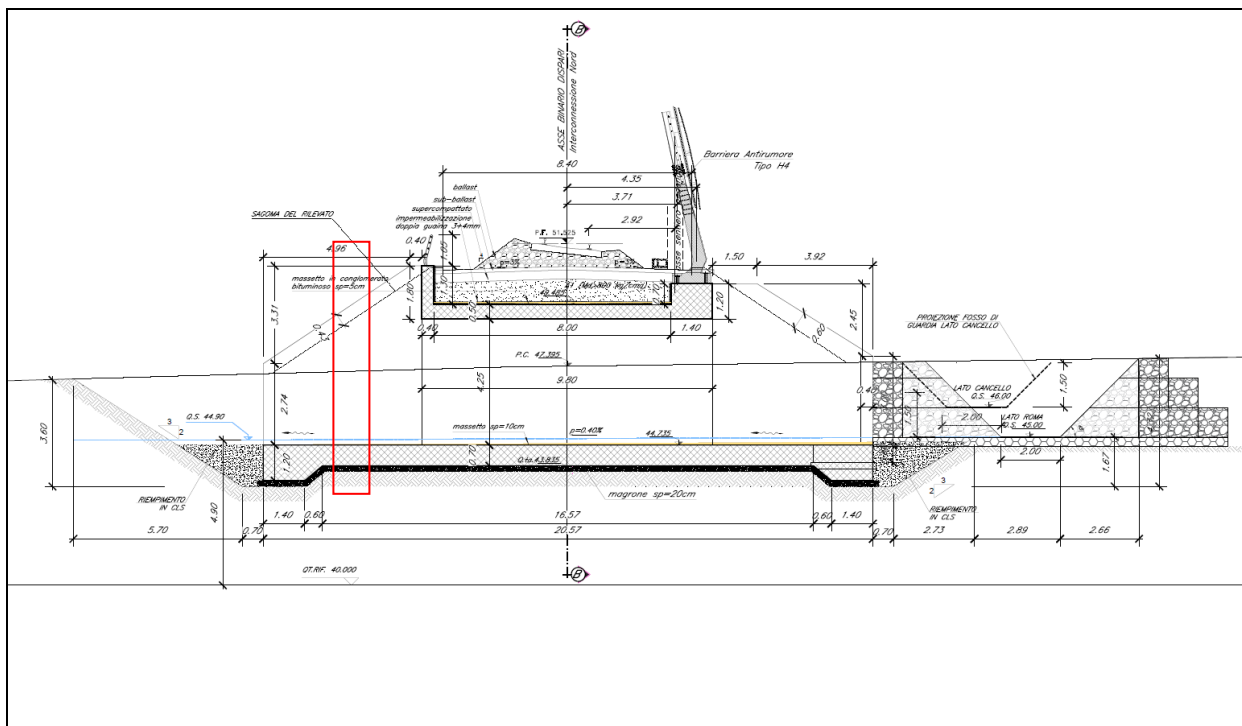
Sezione longitudinale e individuazione delle sezioni SC3 oggetto di verifica.
